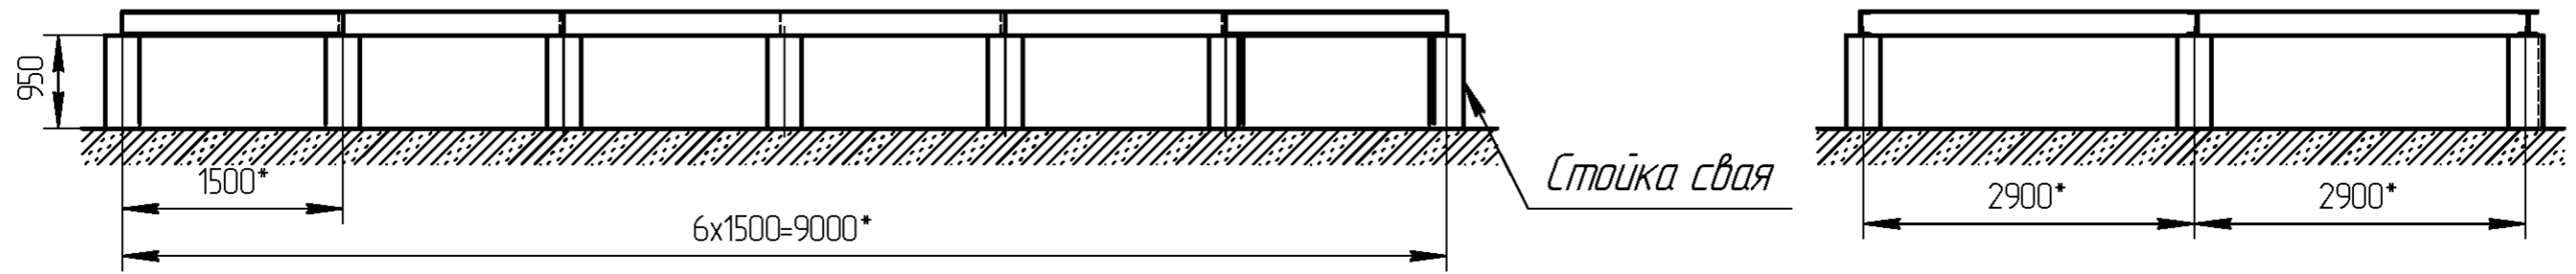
Рекомендации по проектированию фундамента для КРПЗ-35
